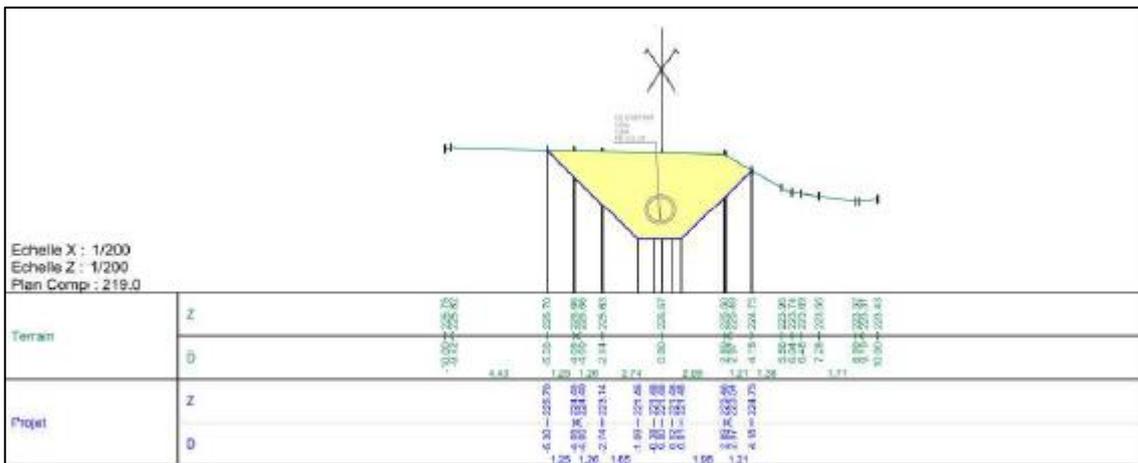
Profil en travers de la dérivation provisoire au 2^{ème} croisement avec le collecteur existant D1200 AT
